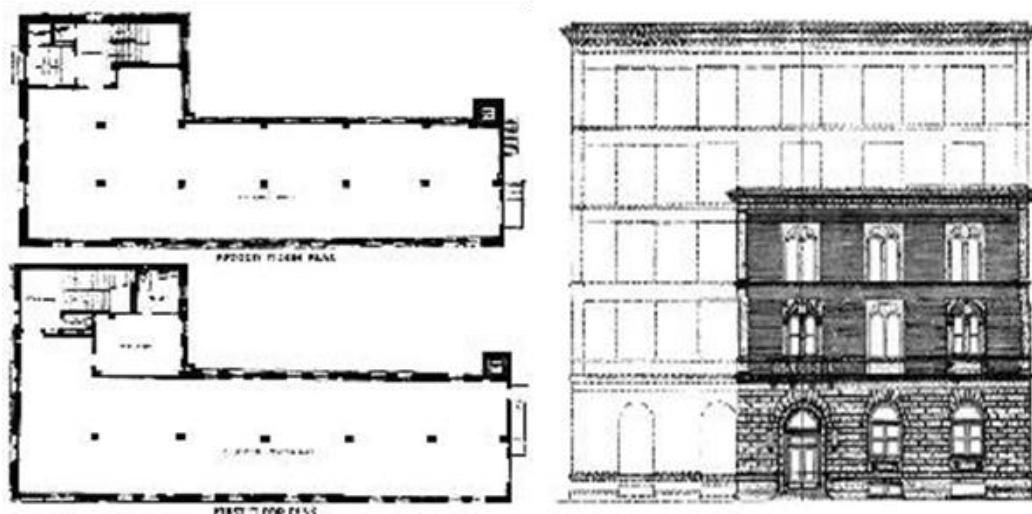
Izquierda, planta de la central McKinley, 1916-1917, *Holabird & Roche*. La forma de “L” permitía disponer de iluminación directa por ambas fachadas en el ala larga, mientras que la corta se dedicaba a servicios auxiliares y escalera. Derecha, alzado con estudio de posible ampliación. Muestra con claridad la racionalidad modular del diseño; la decoración tenía tan sólo un propósito instrumental. *Reproducidos en Bruegmann, 1997.
